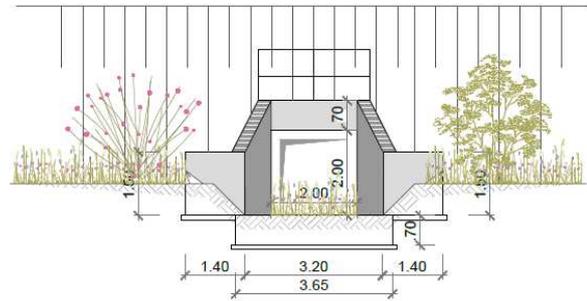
Sezione longitudinale attraversamenti faunistici
